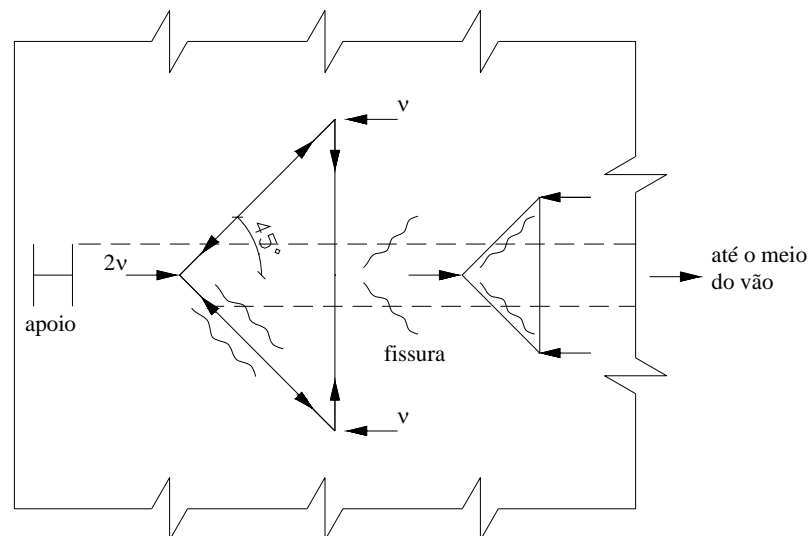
Modelo de treliça para armadura transversal (adaptado de Johnson, 1994).
